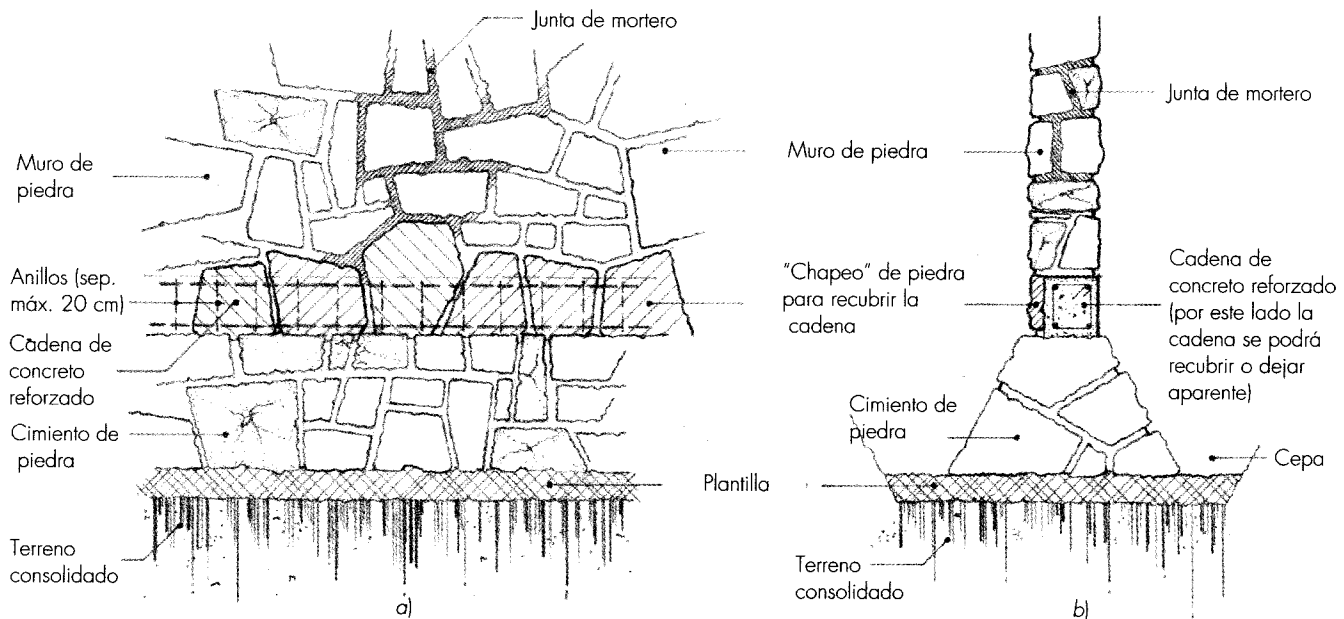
a) Corte longitudinal donde se muestra la cadena de concreto armado. Las piezas sombreadas indican un "chapeo" de piedra cuando se desea que el muro ofrezca el aspecto de muro aparente. b) Corte transversal que muestra la cadena recubierta con piedra por un lado, y mostrando por el otro el concreto aparente.
